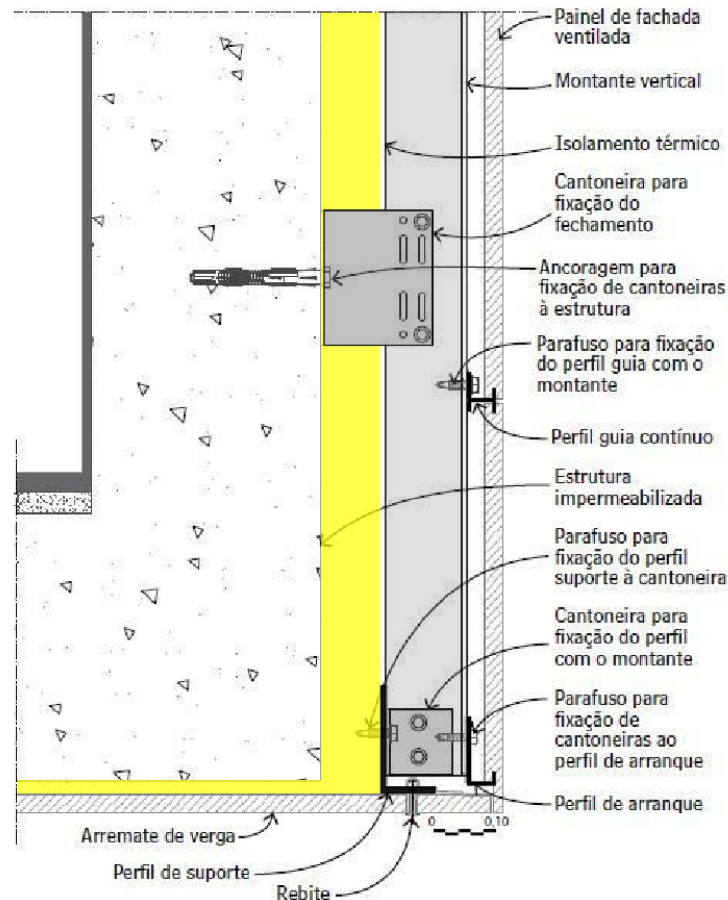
Subestrutura de fixação de fachada cortina com perfil z
